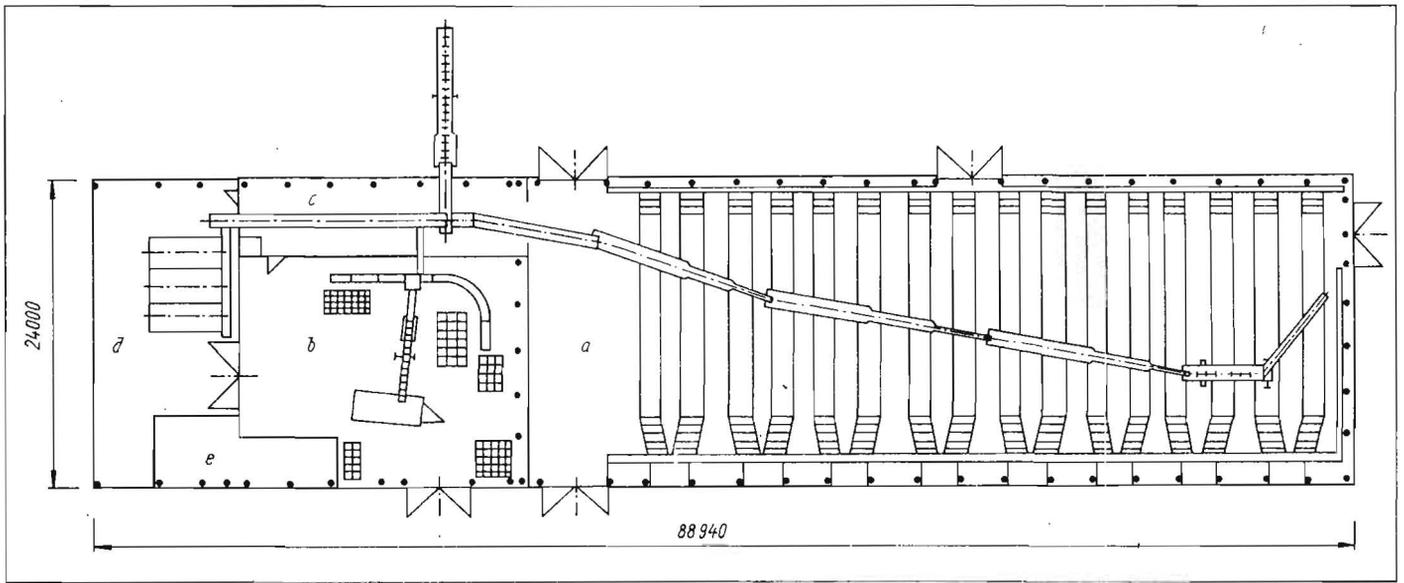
Grundriß des 1,2-kt-Gemüselagers;
